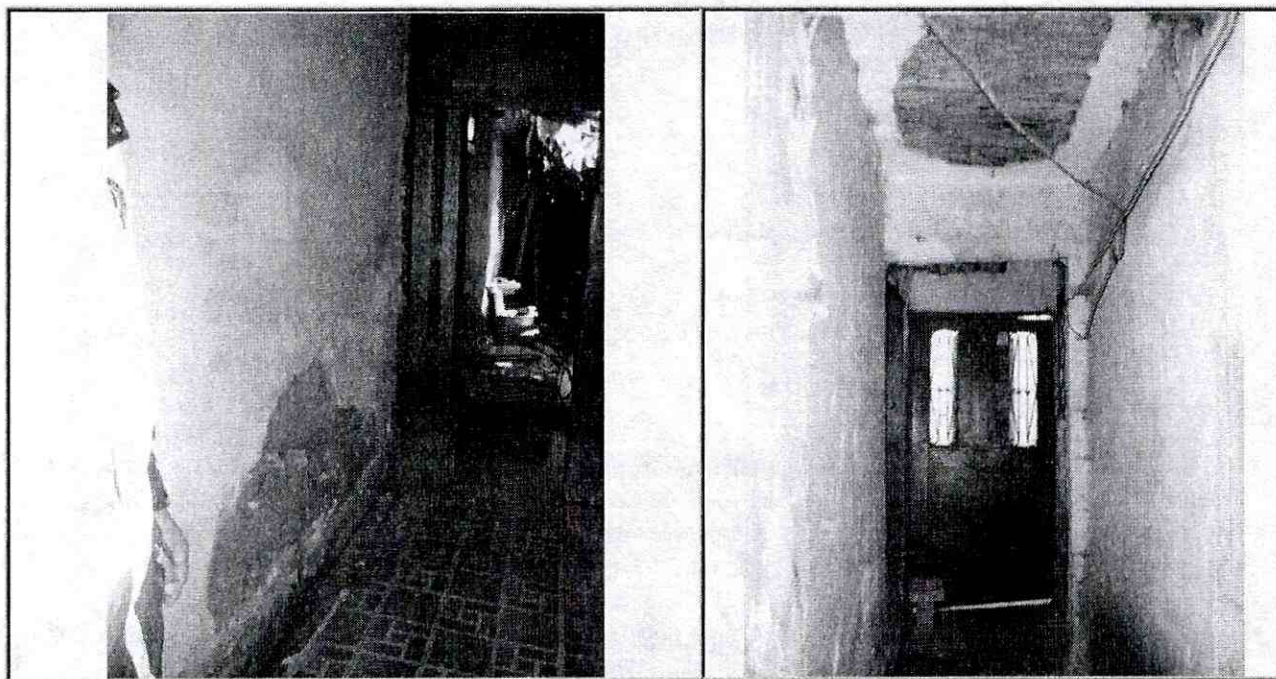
y 4 Vista de la zona de corredores de acceso y circulación al interior de la vivienda
